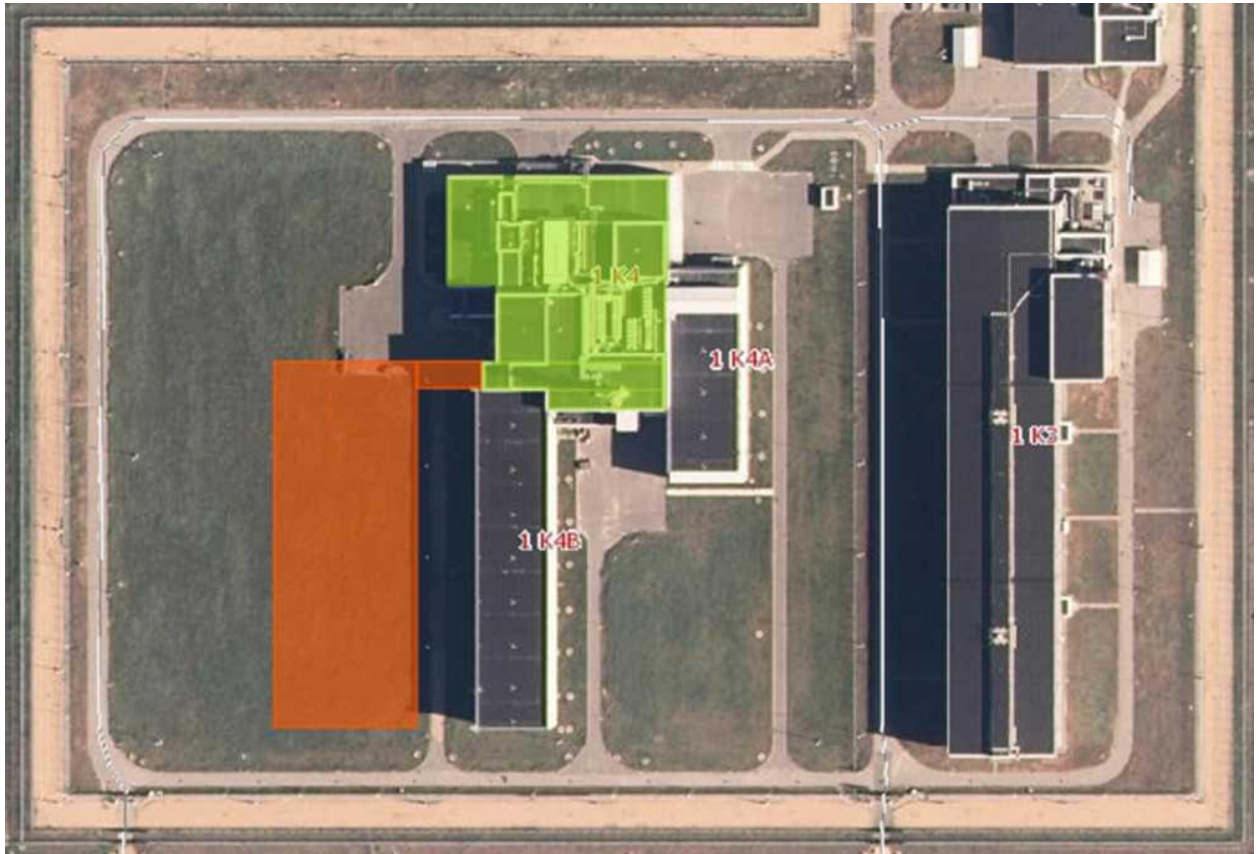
Планируемое расположение ПХОВР на площадке ОПХТРО. Место ПХОВР обозначено розовым цветом, здание ОПТРО – зелёным
